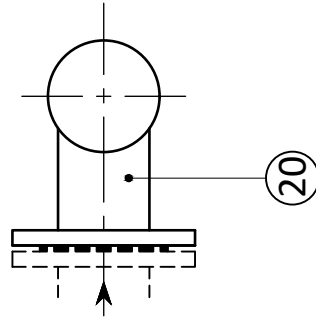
DETAIL C - UITLENGING BOVENGRONDSE BRANDKRAAN MET PVC-U LEIDING
